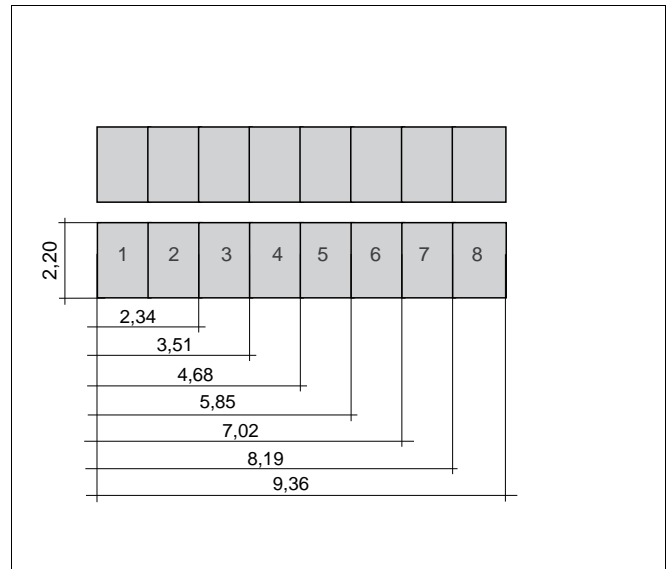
Senkrechte Ausführung (Alle Maße in mm)
